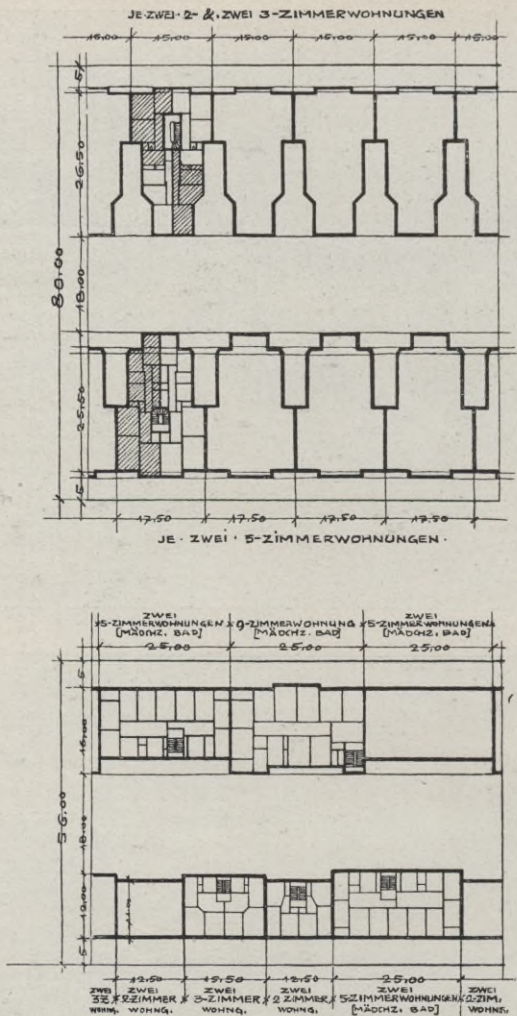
Schema eines Blocks in Hintersflügel-Bauweise (Hamburger System) und Schema eines Blocks von Häusern mit nach der Zimmerzahl gestaffelten Bautiefen.
